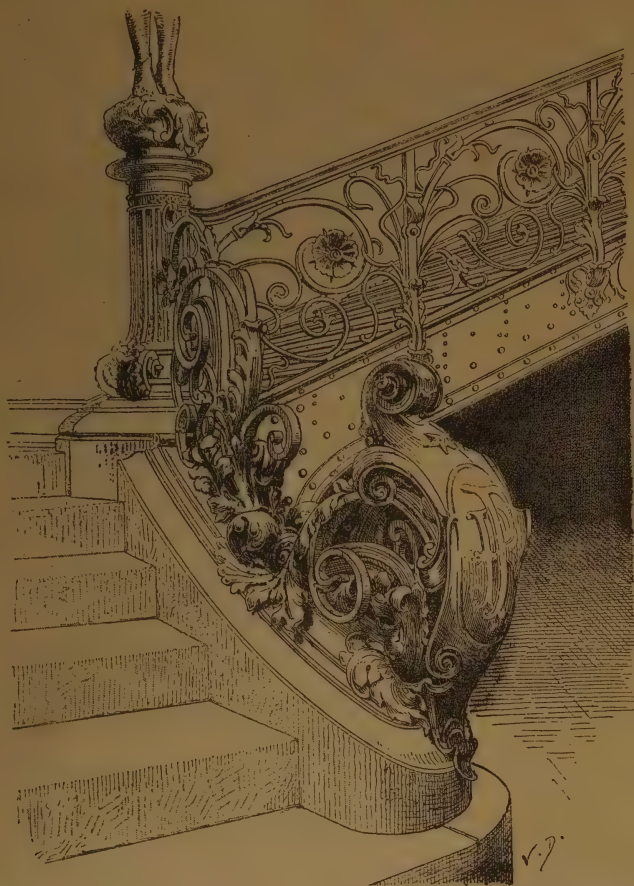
Départ d'escalier à la galerie des Machines, Exposition de 1889.
